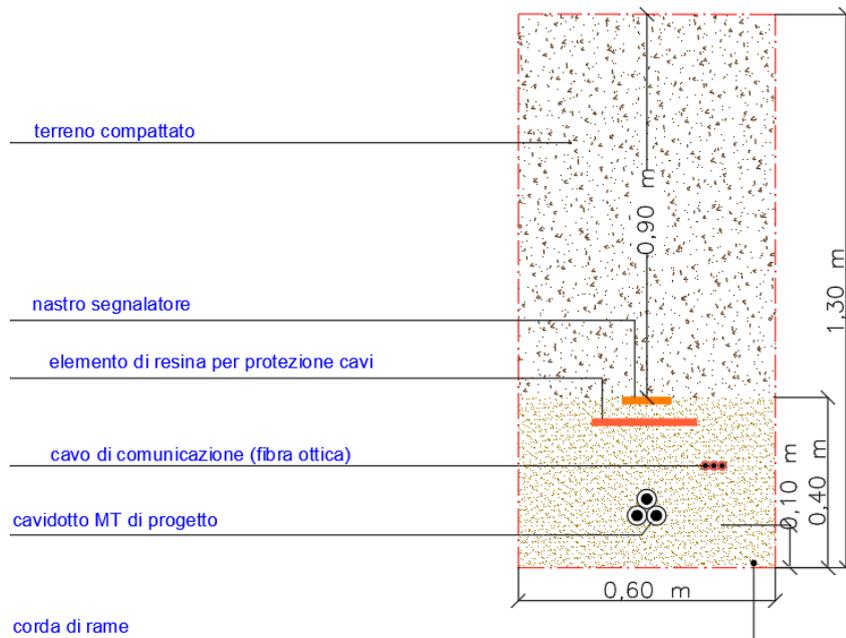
Sezione Cavidotto Singola Terna di cavi su terreno
